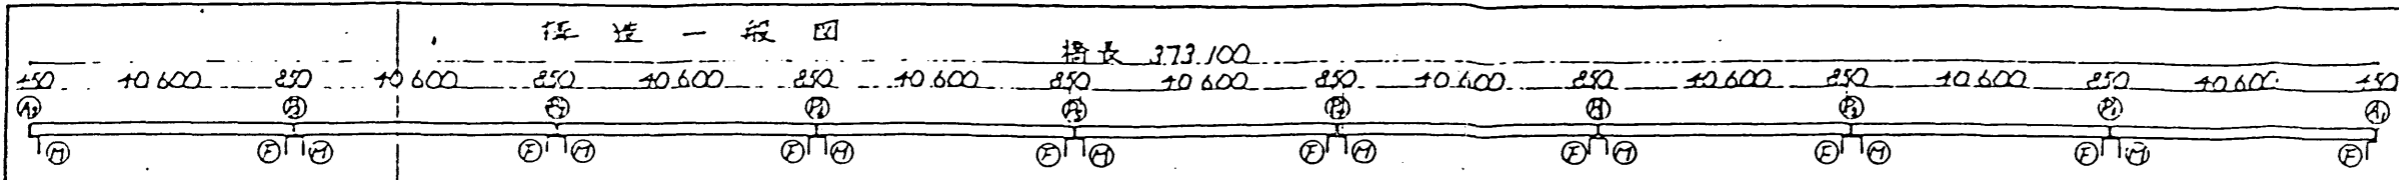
施工時ひびわれの例 橋梁橋脚
